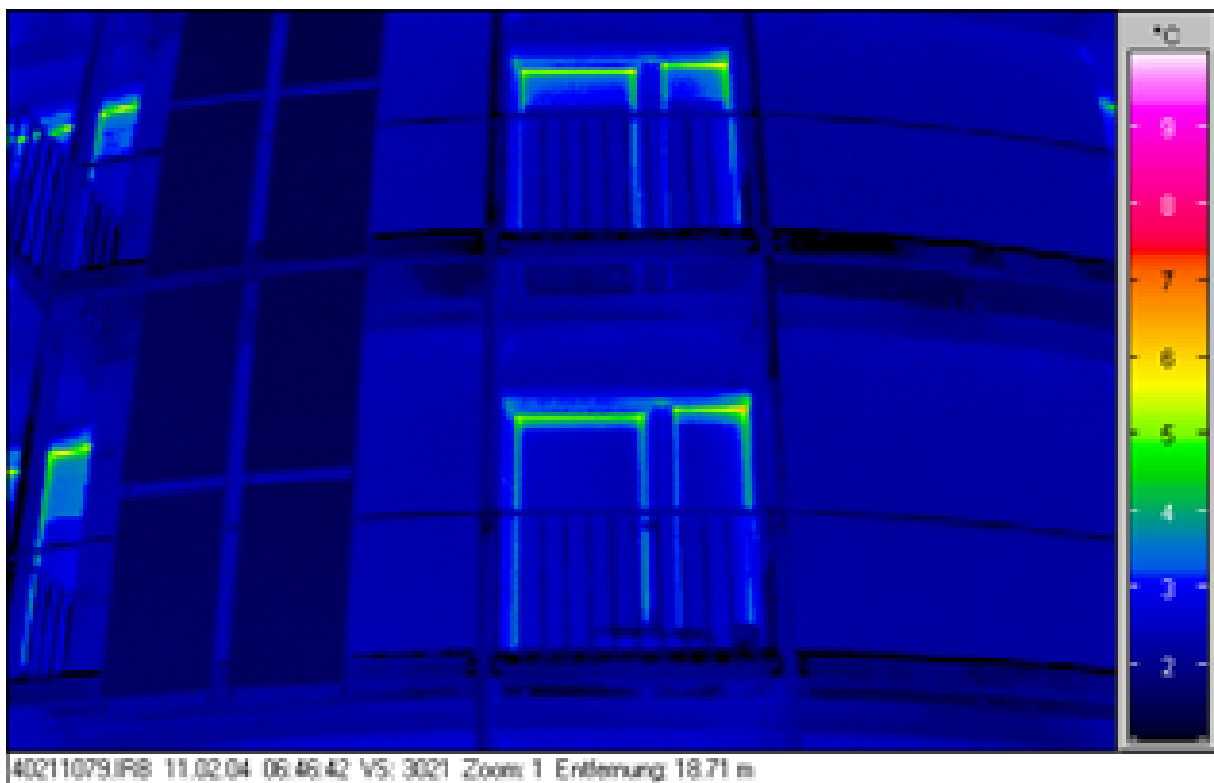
Detail Südost-Fassade mit Balkonanlage und PV-Modulen.
